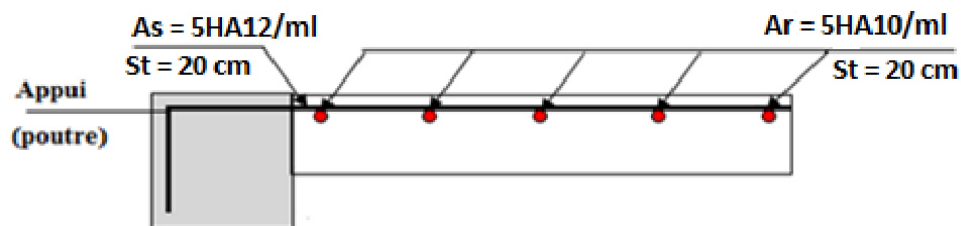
Schéma de ferrailage de la dalle pleine.
